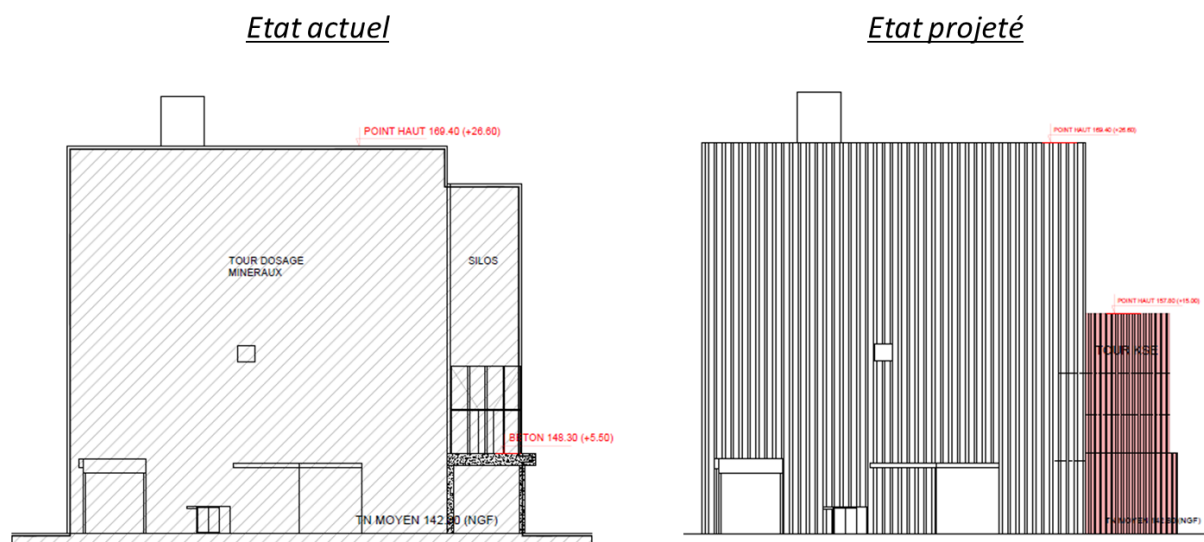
Plan de coupe avant et après travaux de la tour de fabrication où sera installée la tour KSE (source : Permis de construire)
